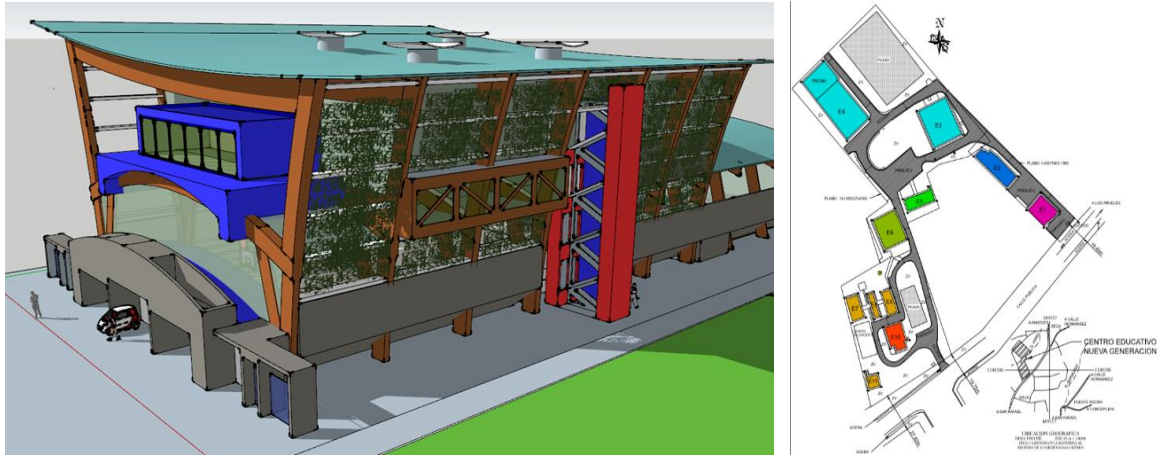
Fachada sur este, propuesta de modelo mejorado. Elaborado por el autor. (2019).
